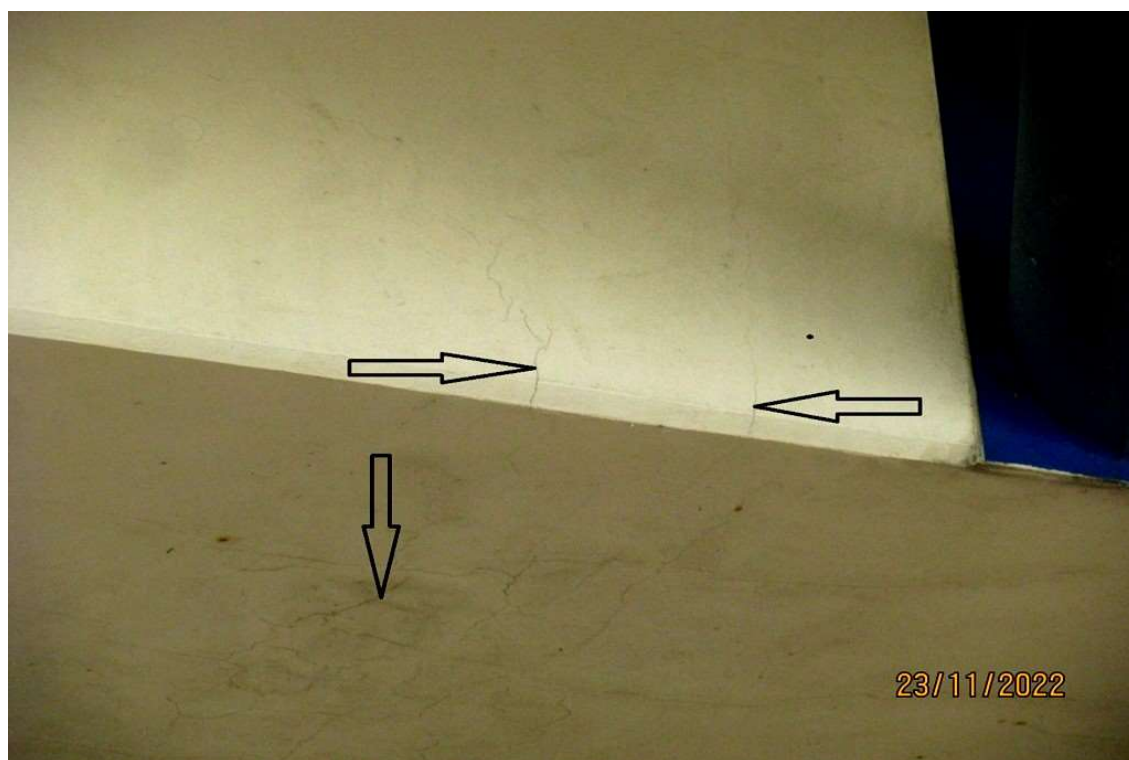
Oparcie przęsła na przyczółku z zaznaczeniem zarysowań betonu.
